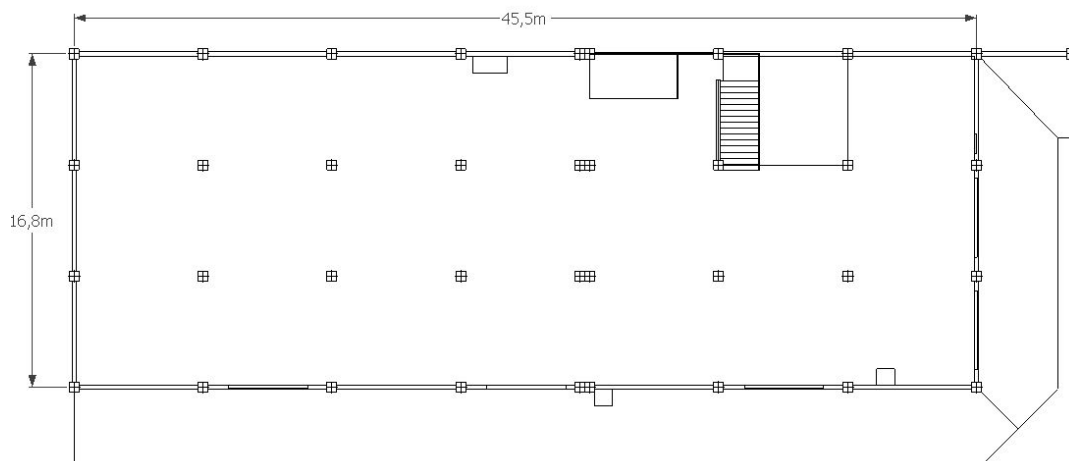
Planta Baixa CD Salvador (fonte: elaboração própria)
